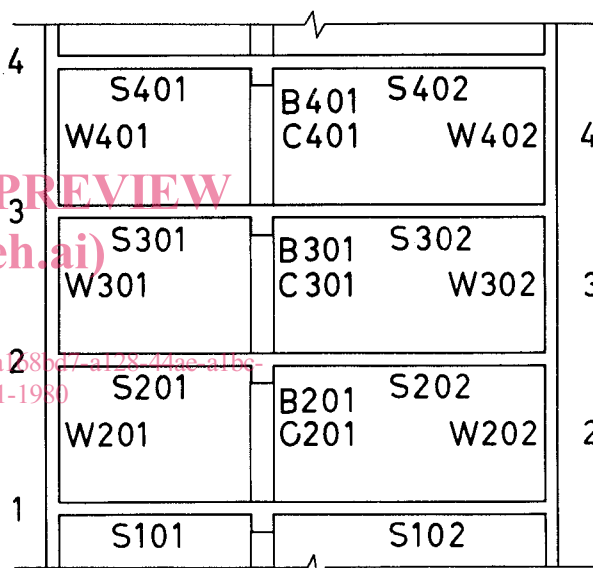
Exemple de désignation des colonnes, planchers, murs, poutres, etc.
